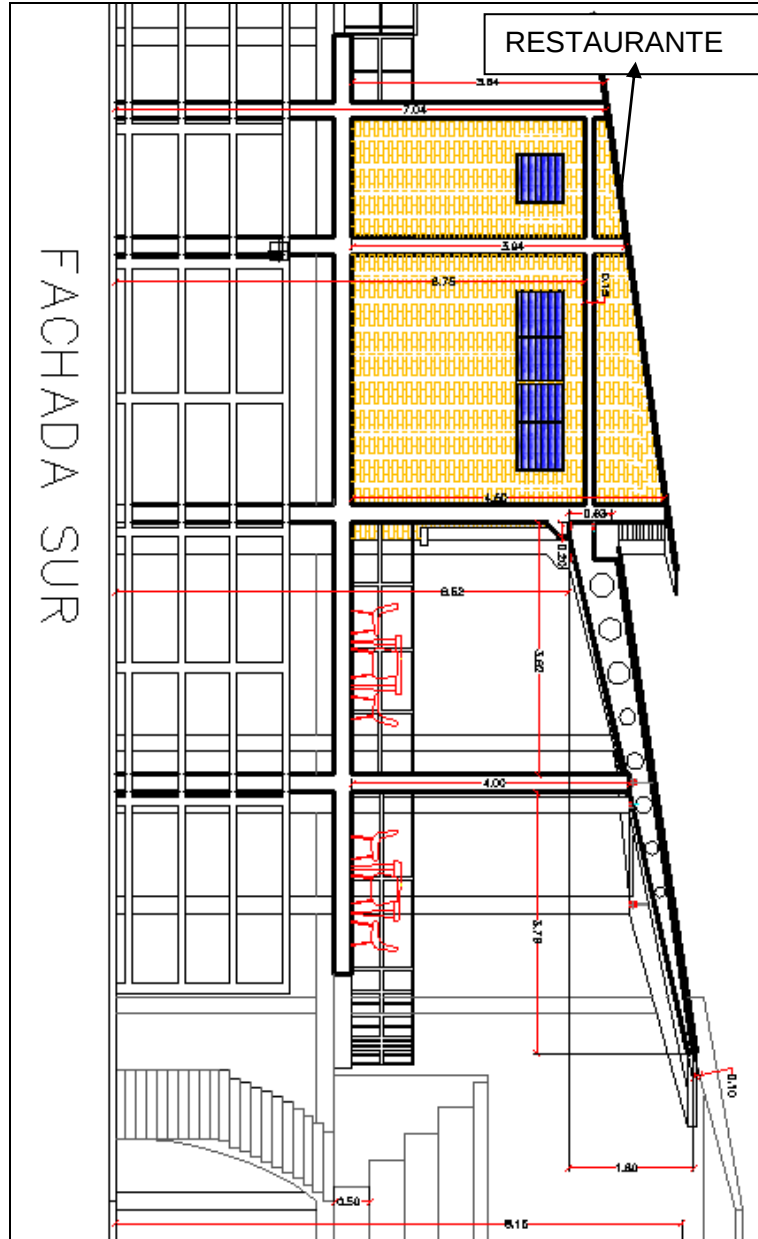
Planta de entrespiso restaurante coliseo de ferias.
